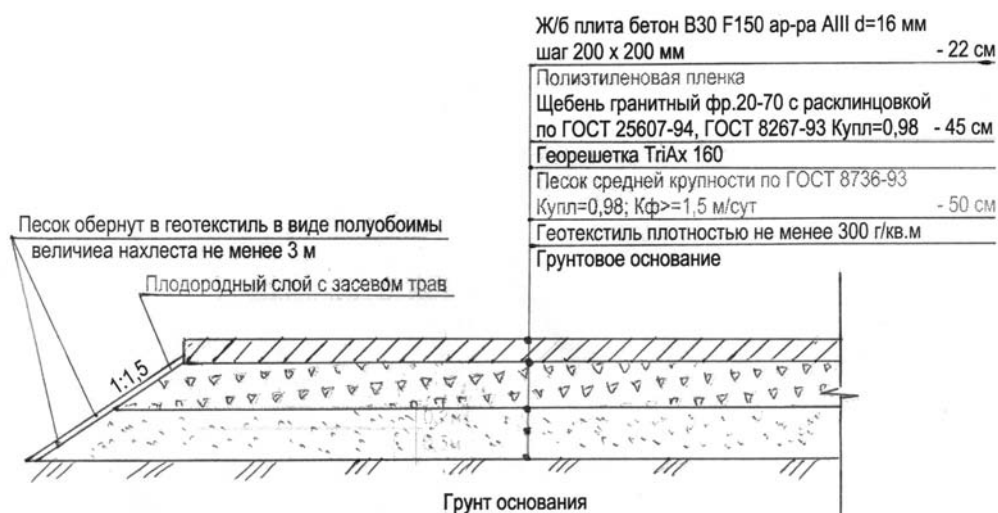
Проектируемое монолитное железобетонное покрытие.
